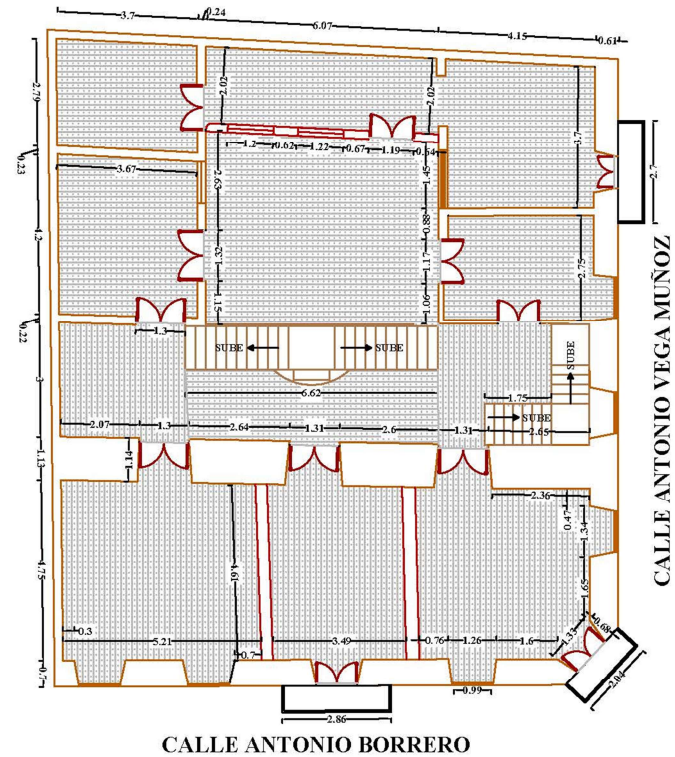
Arquitectura a detalle: Distribución Planta baja y primera planta alta. Elaboración propia.
